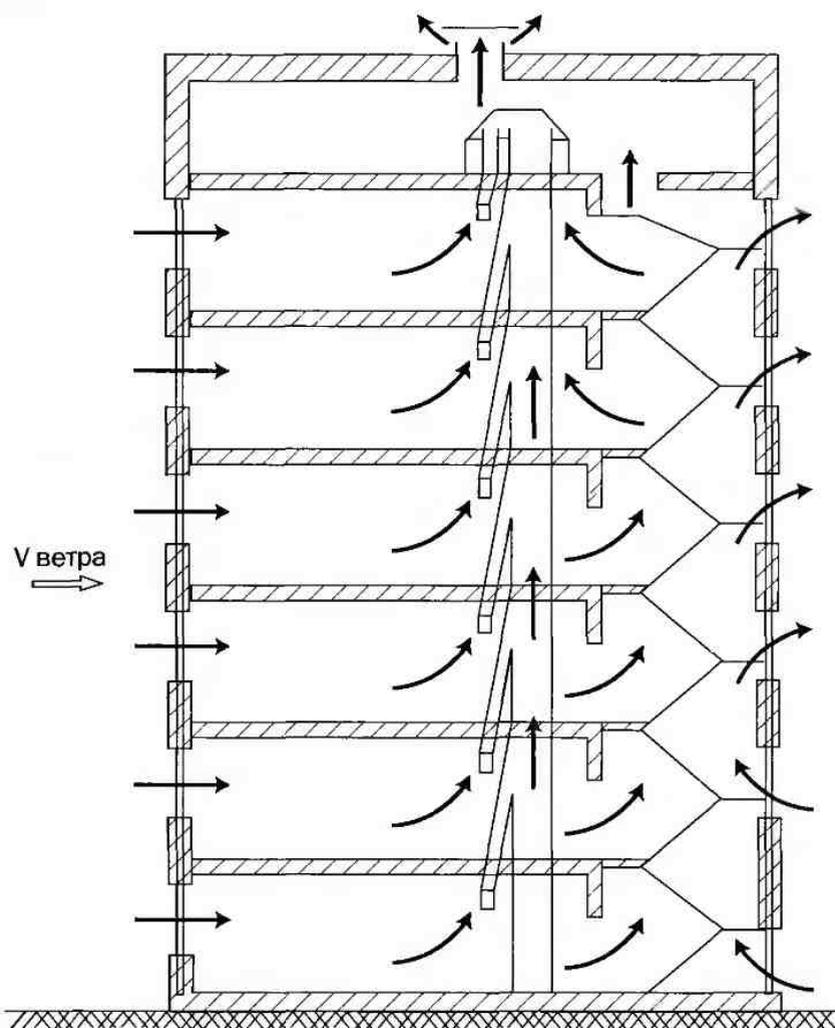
Формирование воздушных потоков в многоэтажном здании с естественной вентиляцией
